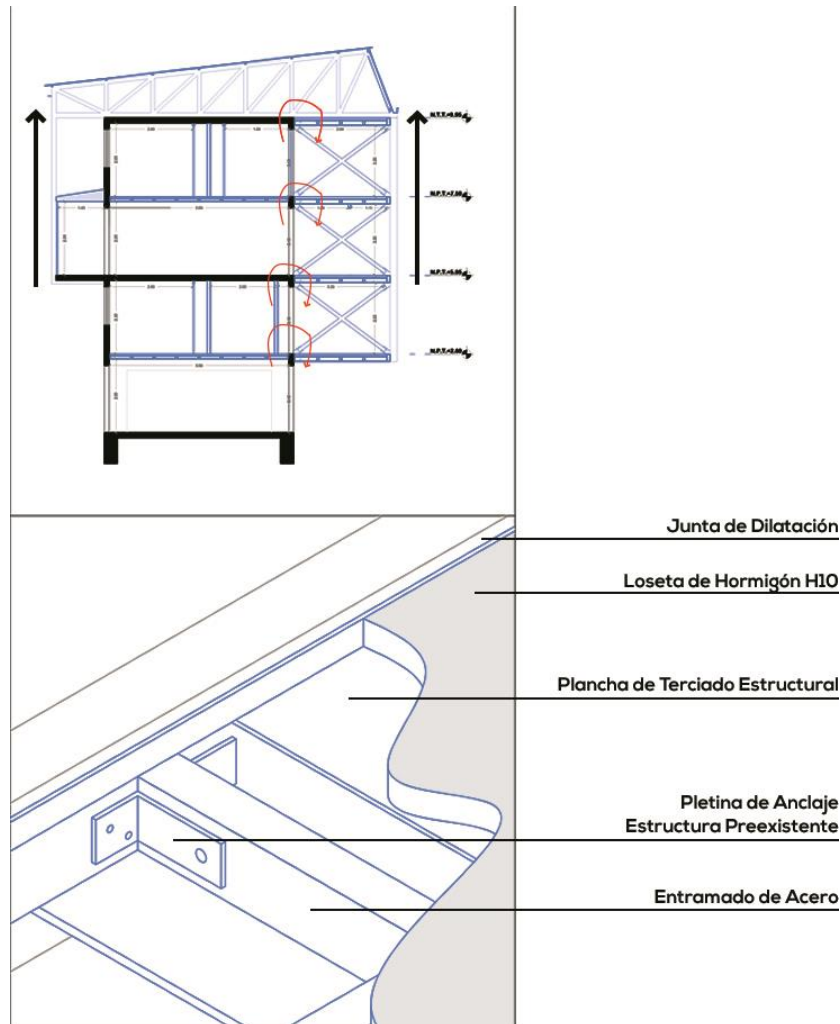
Esquema Estructural + Detalle Pletina de Anclaje. Fuente: Elaboración propia.
